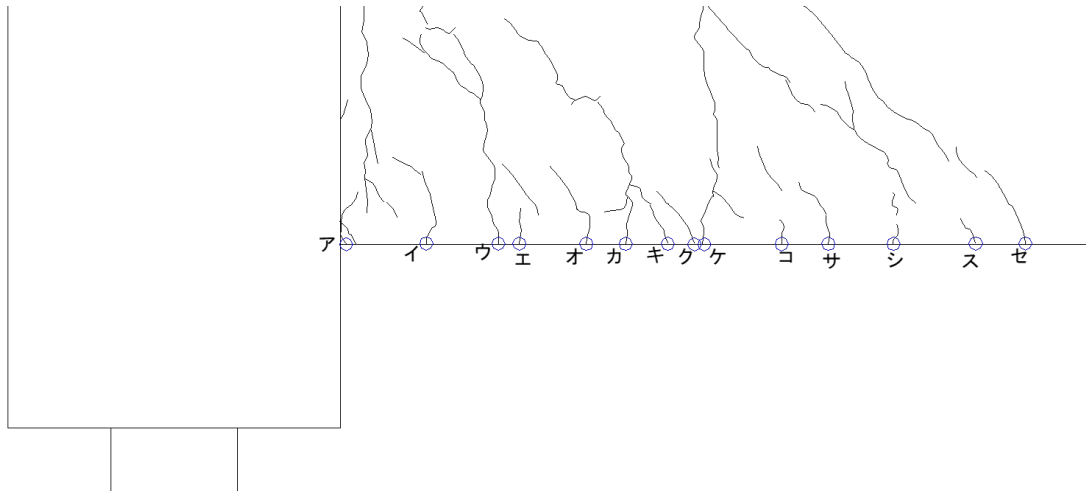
基礎梁ひび割れ幅測定位置(試験体 A-2 正載荷)
